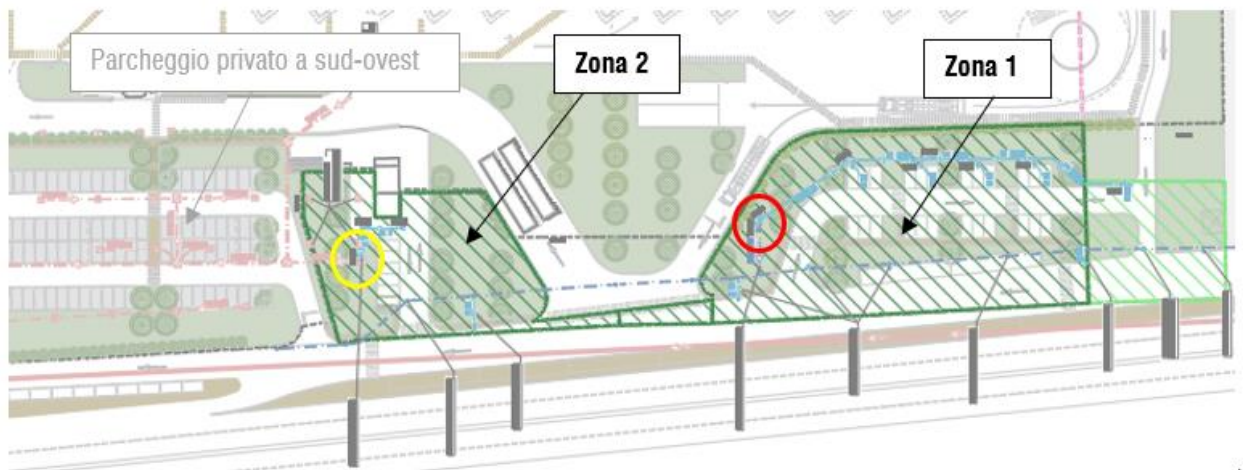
Individuazione delle zone in cessione oggetto di intervento
